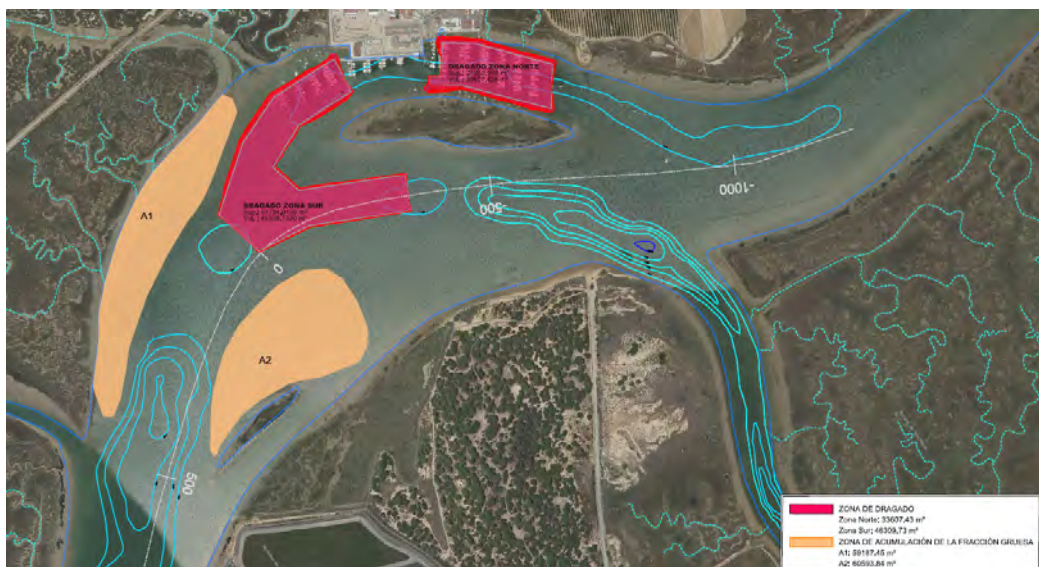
Planta de la propuesta de dragado en el puerto de El Terrón.
